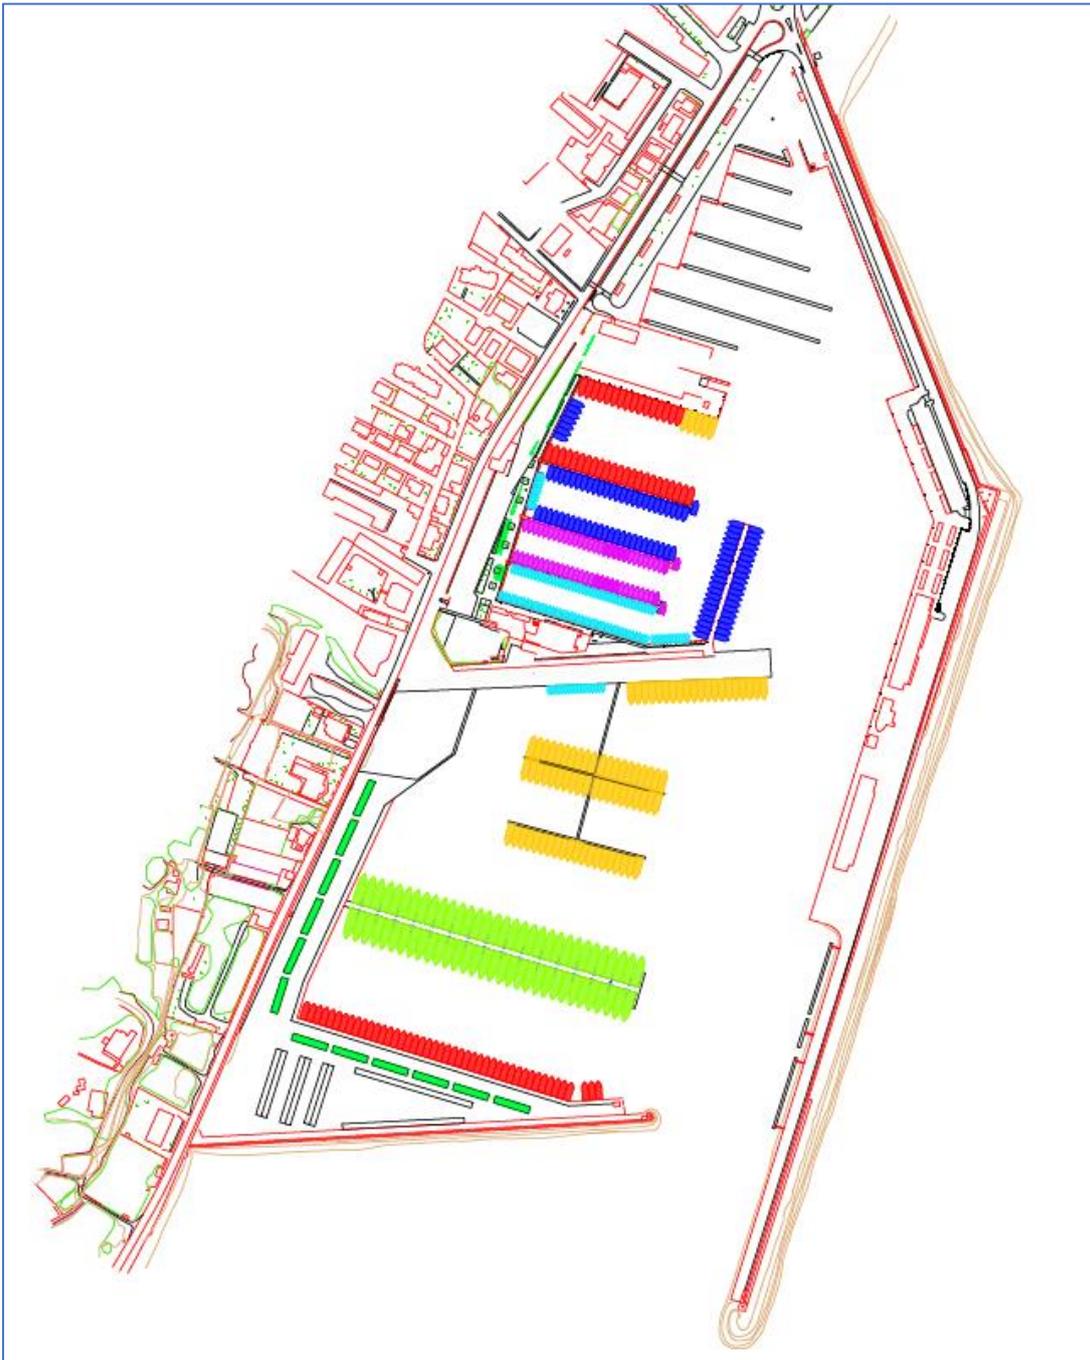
Vista en planta de la solución elegida. (Fuente: Elaboración propia)
